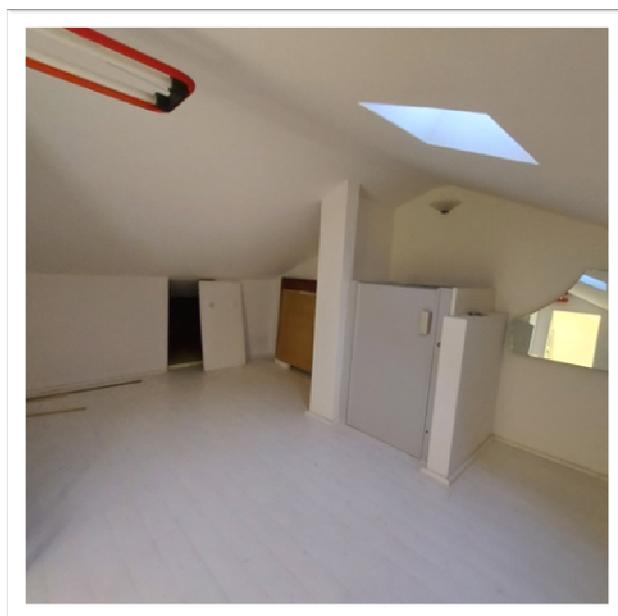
PS Vano2 (part. piattaforma elevatrice)
